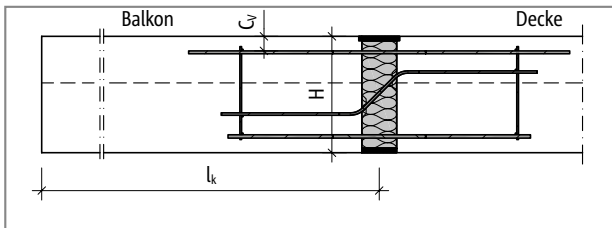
Schöck Isokorb® XT Typ BP: Statisches System
